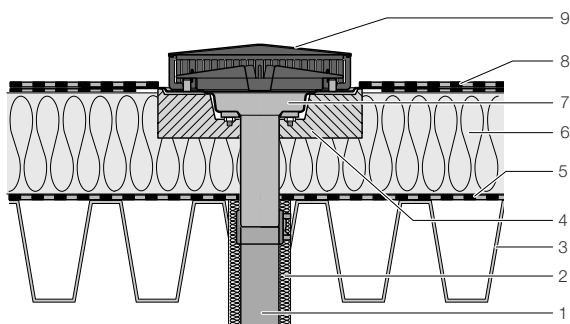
Конструкция легкой кровли, изолированной, с битумным кровельным покрытием
